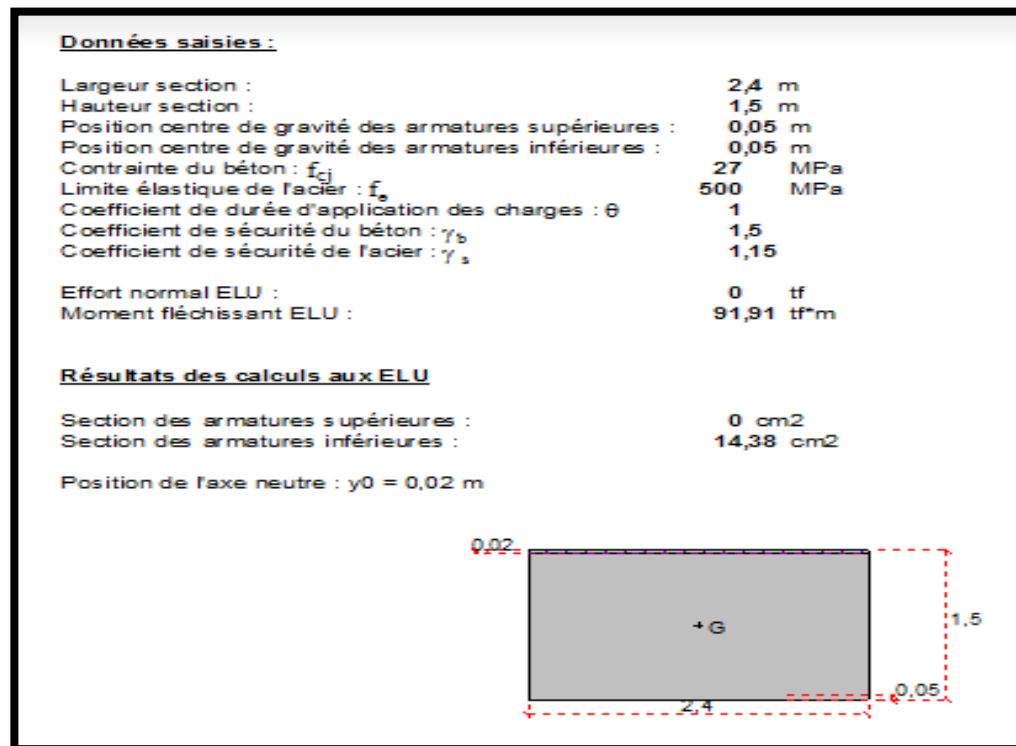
Calcul de la section d'armature tendue (supérieure) en travée à l'ELU.
